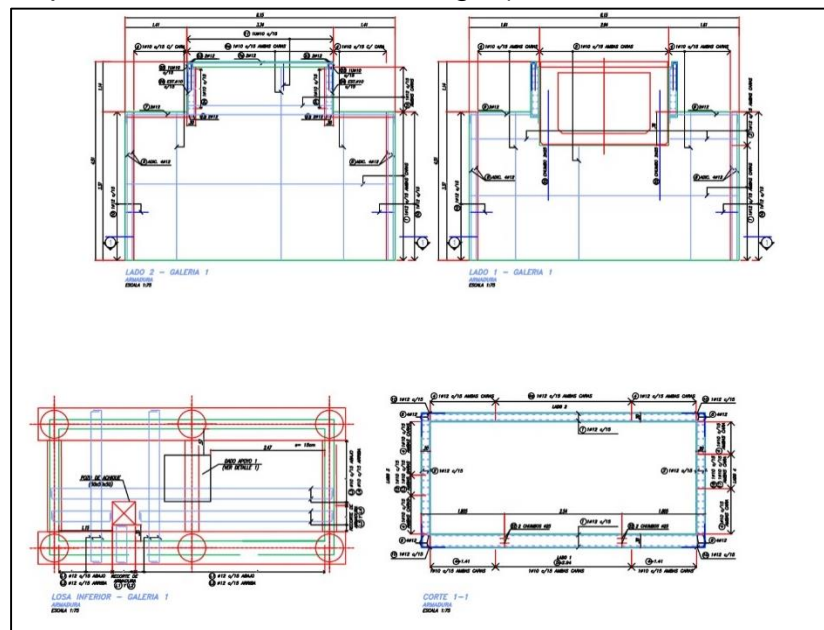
Detalle galería 1. (PLANO N° 29)
